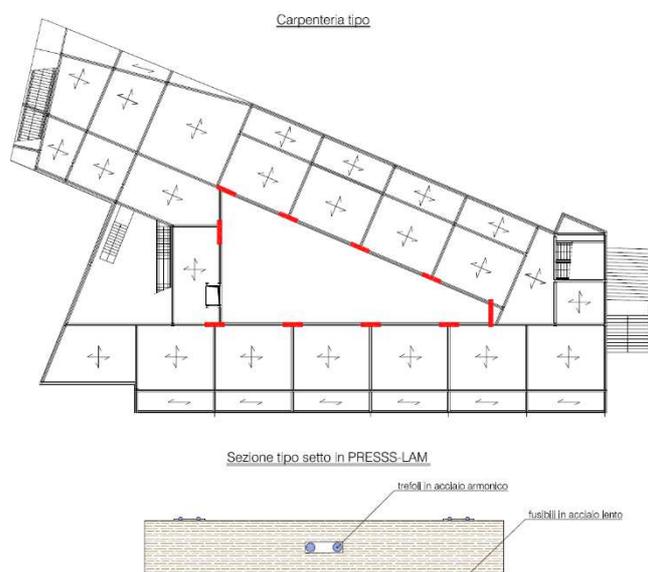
Carpenteria piano tipo con evidenziazione dei setti in PRESSS-Lam
